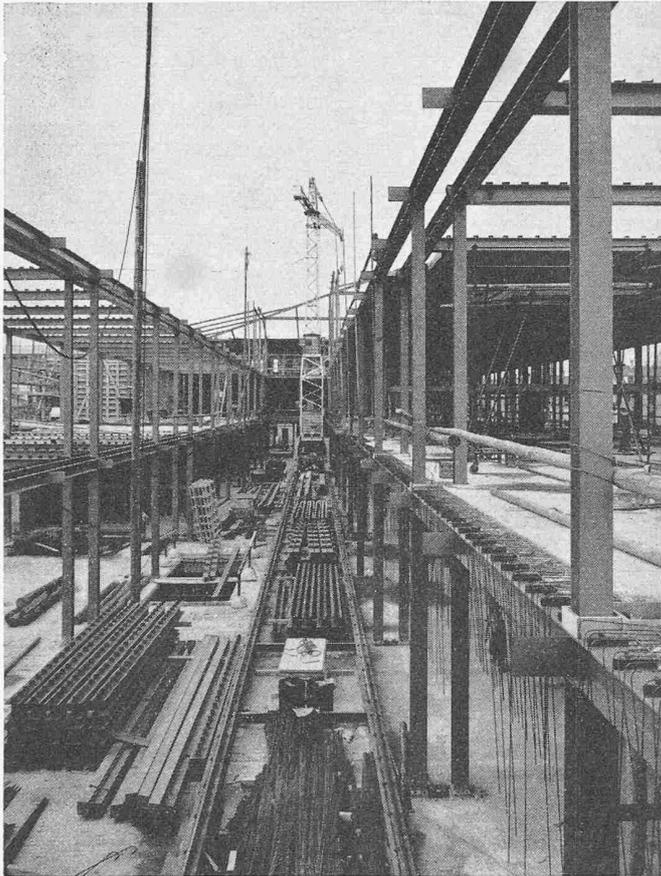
Baualt 1. Turmkran auf dem Erdgeschossboden zur Montage der Stahlkonstruktion (Querriegel mit Schubdübeln) und zur Erstellung der Eisenbetondecken
